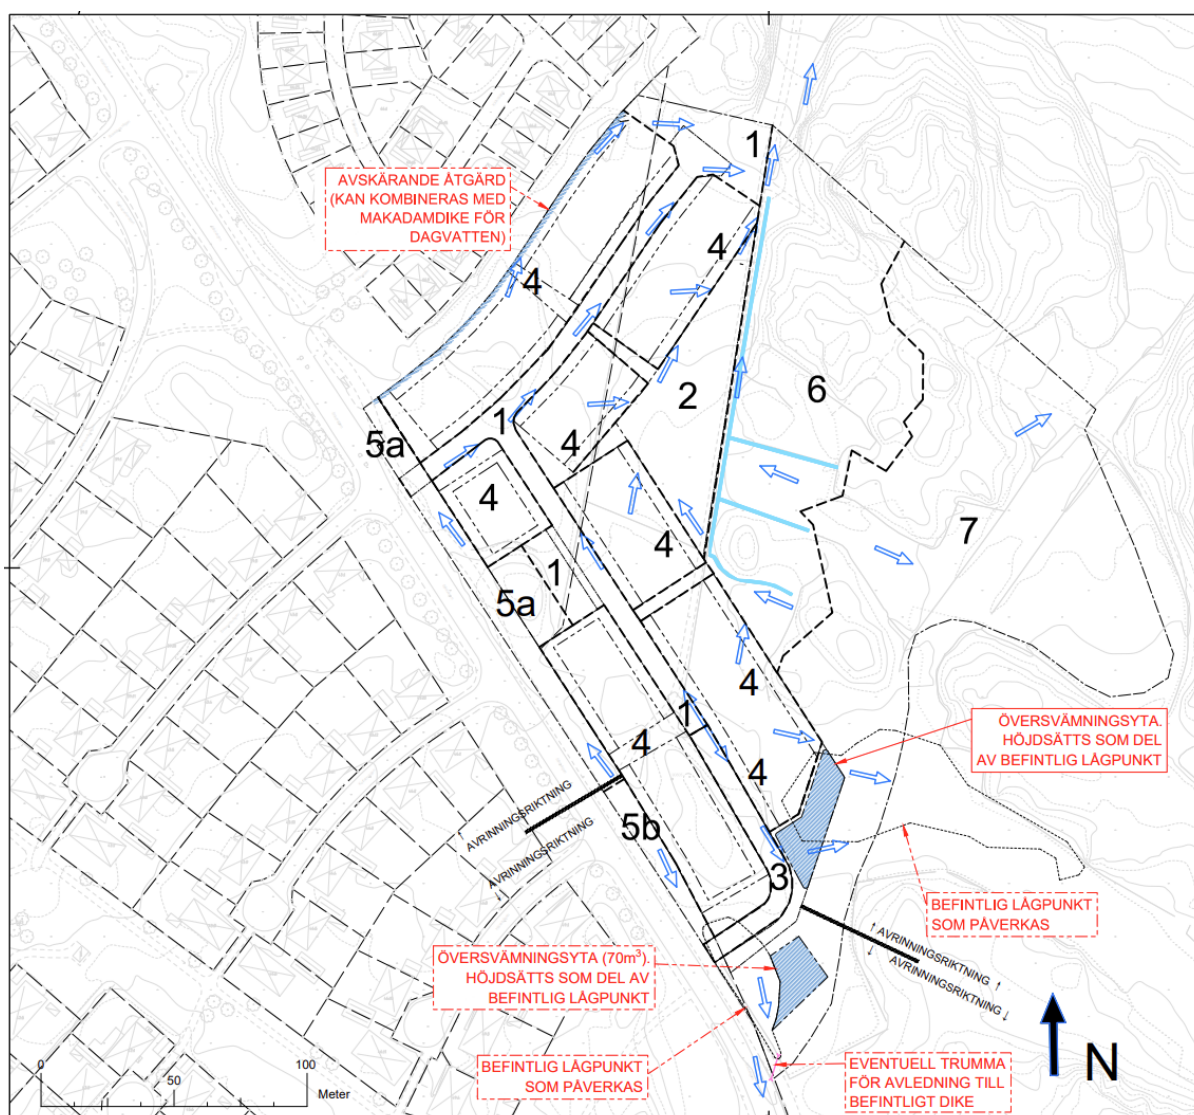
Föreslaget svackdike med dämmen norr om planområdet.
